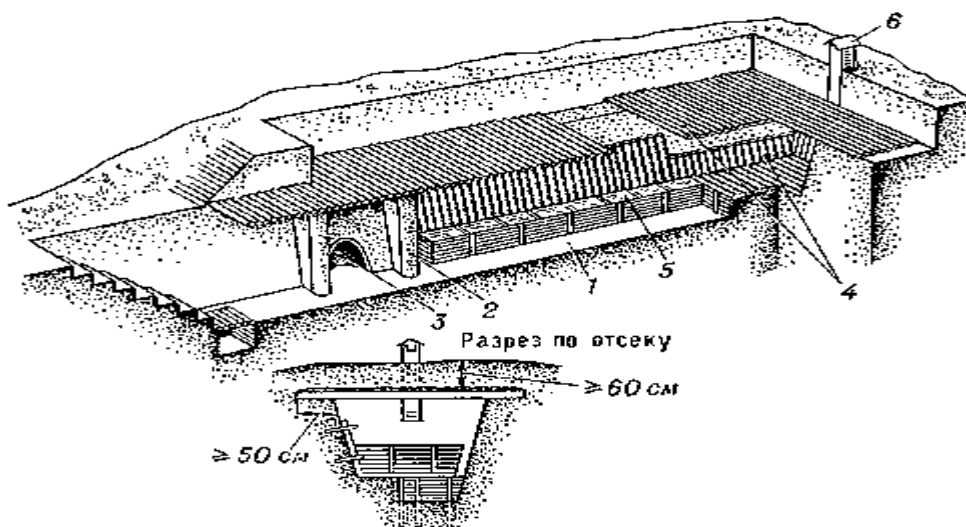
Противорадиационное укрытие из лесоматериалов: 1 — помещение для укрываемых людей; 2 — занавесы на входе; 3 — ниша для выносной тары; 4 — покрытие и одежда стен из подтоварника; 5 — скамьи для укрываемых людей; 6 — вытяжной короб.
